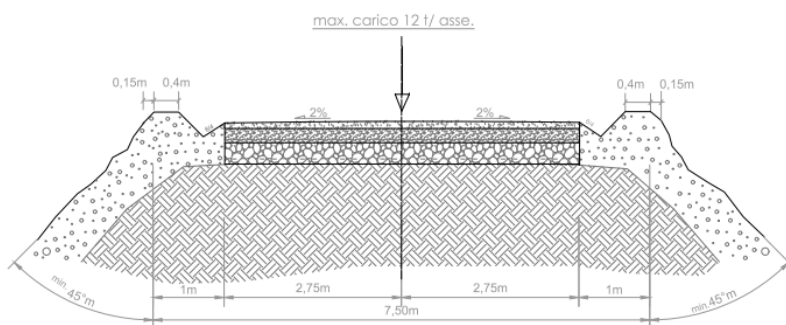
Sezione stradale tipo a doppia scarpata (in rilevato)
